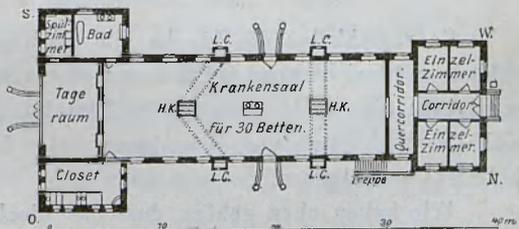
Grundriss eines Pavillons des Krankenhauses Hamburg-Eppendorf nach Denecke.
